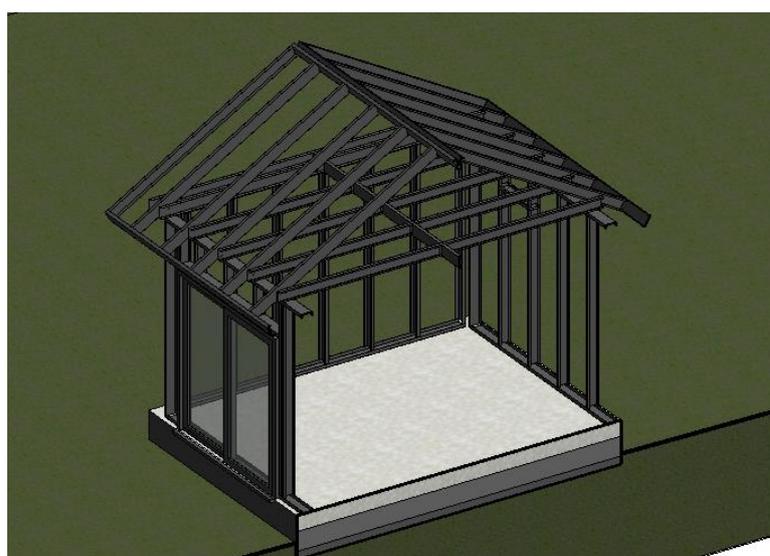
Corte do modelo tridimensional (estrutura de teto e cobertura)
